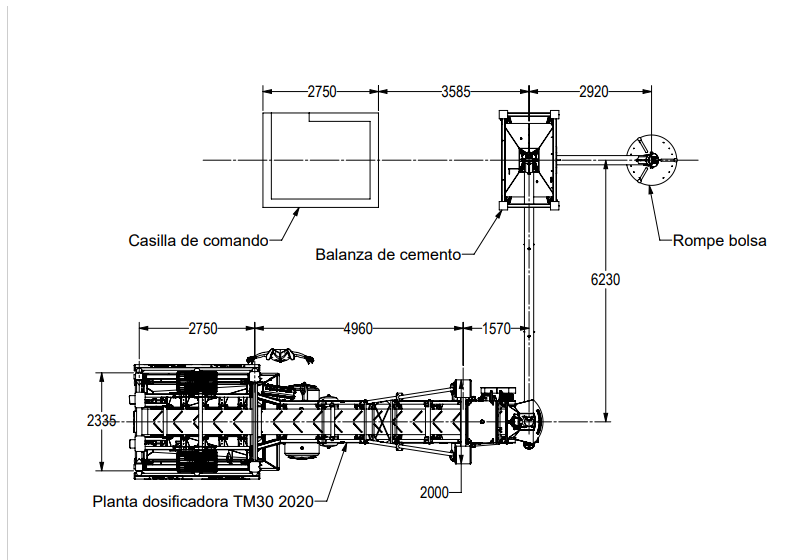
PLANTA TM 30 CON ROMPE BOLSA
